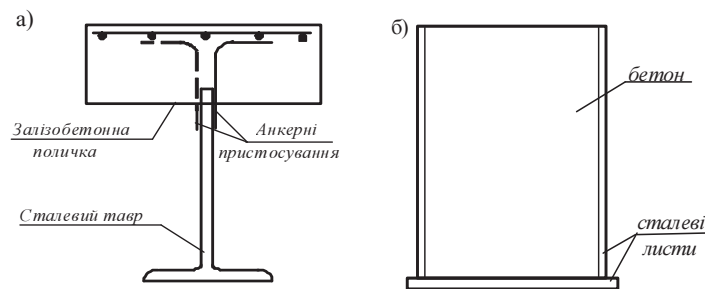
Поперечні перерізи сталезалізобетонних балок:
